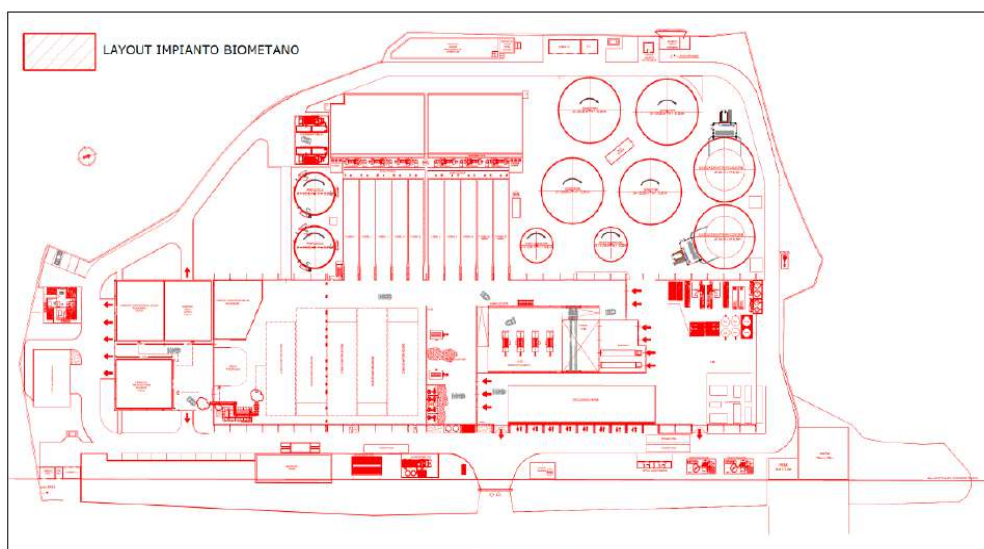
Planimetria generale di progetto - RC1 rev.02 "Relazione descrittiva generale" – marzo 2023
